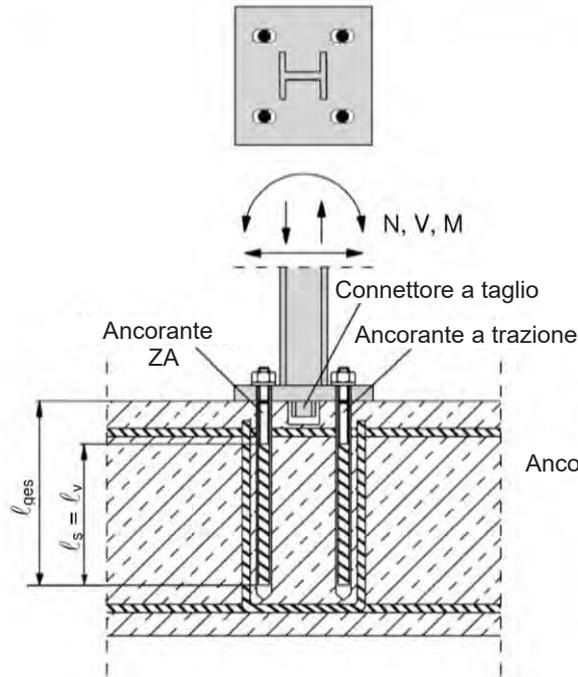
Giunto di sovrapposizione per l'ancoraggio dei pilastri da barriera
